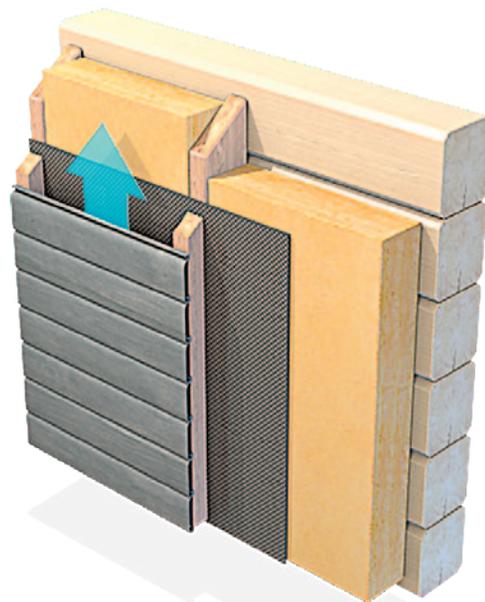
Конструкция дополнительного утепления наружных стен из бруса. Слева направо: сайдинг, вентилируемый воздушный зазор, ветрозащитная мембрана, установленная в каркас теплоизоляции, стена из бруса
